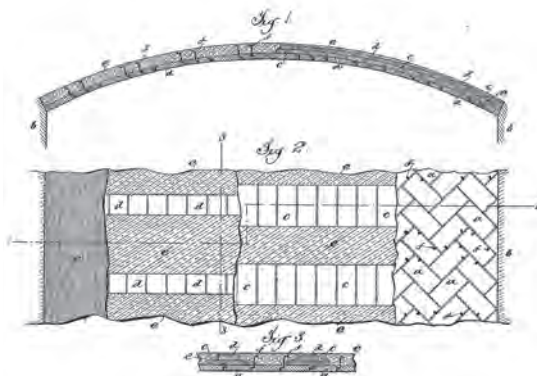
Rafael Guastavino Expósito, 1892. *Construction of Fire Proof Buildings*, 01. Fuente: US Patent N° 468871, February, 1892.
